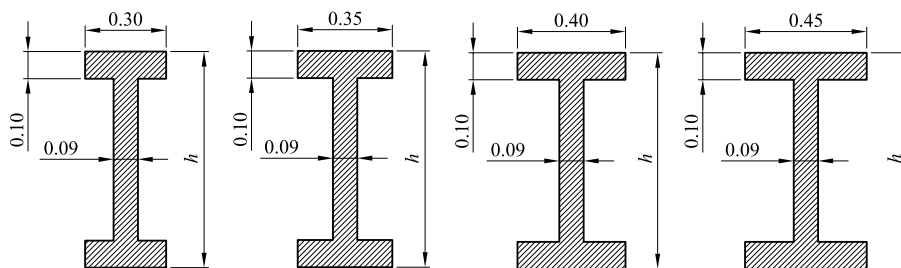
Series de vigas auxiliares de hormigón pretensado consideradas
